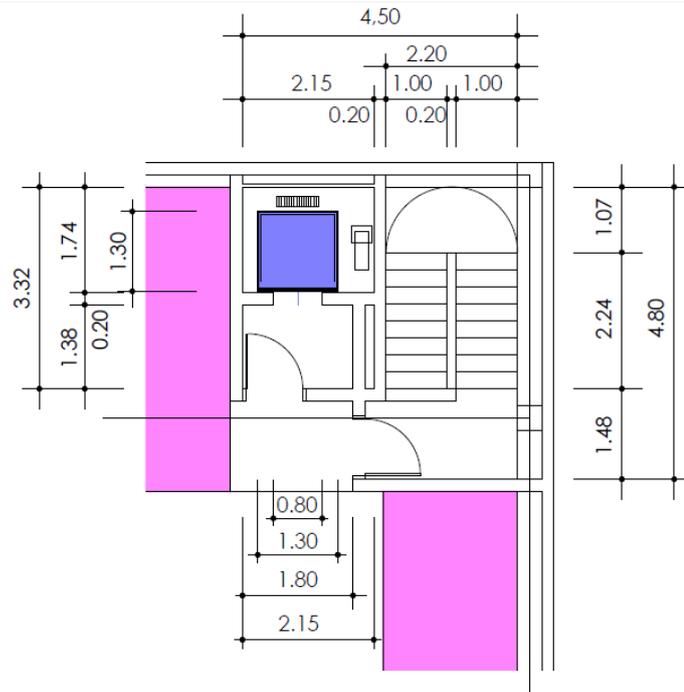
Detalle en planta del núcleo de comunicación vertical del diseño (Elaboración propia)
